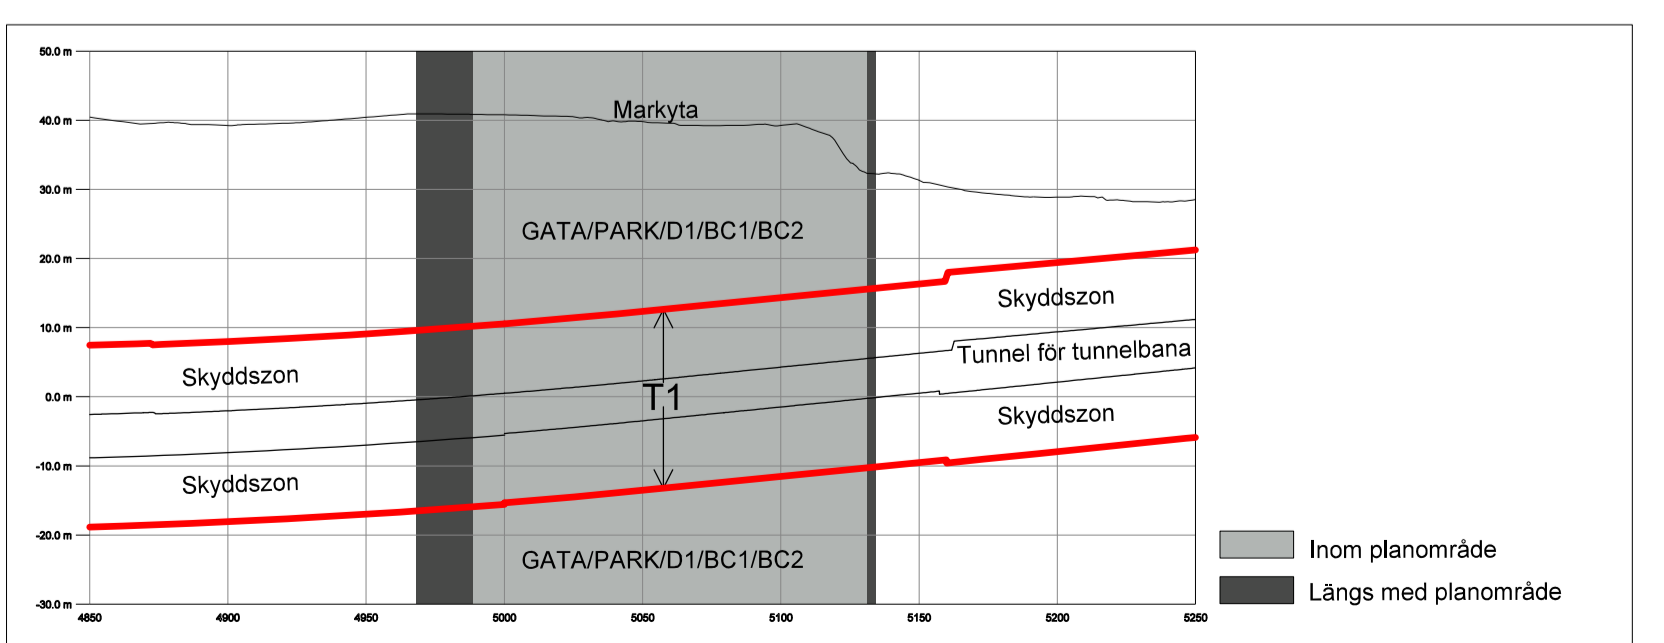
Visar lägsta skydsklip inom planområdet samt läge för profilering för tunnelbanan. Profileringen är markerad i rött. Användningen T1 avgränsas i bredd av streckade linjer i svart (användningsgräns). Streckade linjer norr och söder om planområdet visar profileringens utsnitt. Skala 1:1000. Höjdsystem RH2000.
